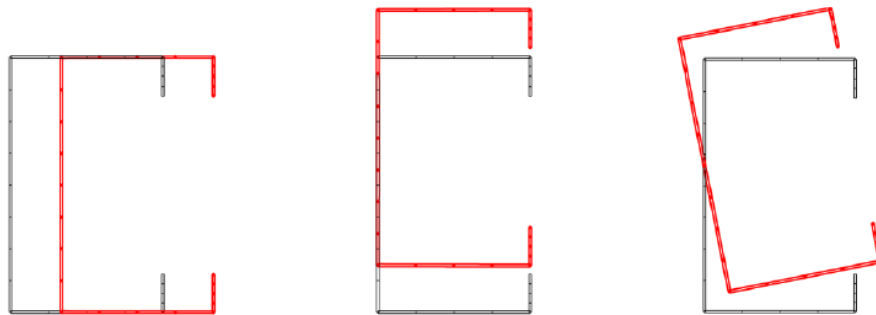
Instabilités globales d'une section en C uniformément comprimée
